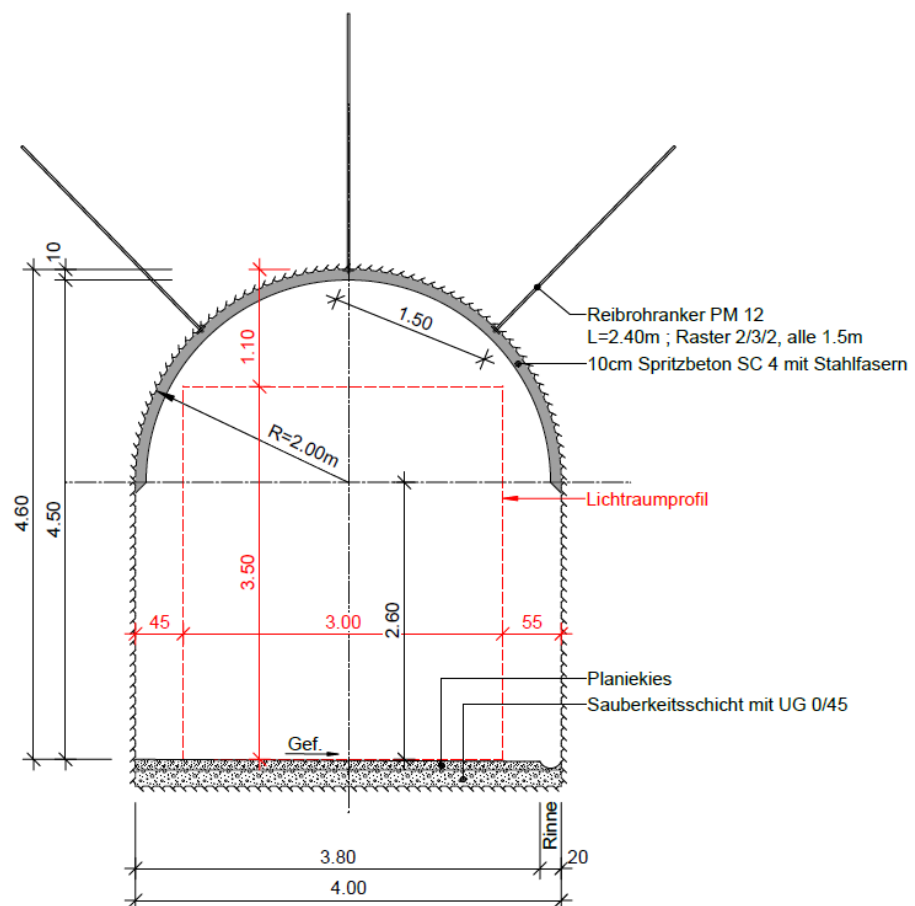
Skizze Ausbau mit Sicherungstyp 2. Quelle: Beilage Techn. Bericht Gasser Engineering AG (siehe Anhang A3).
